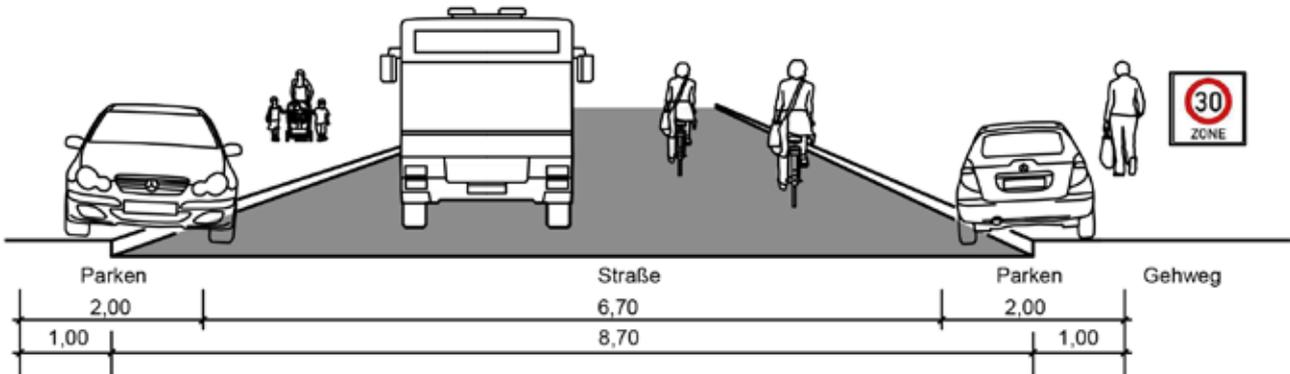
Straßenquerschnitt, Bestand Holzhausenstraße
